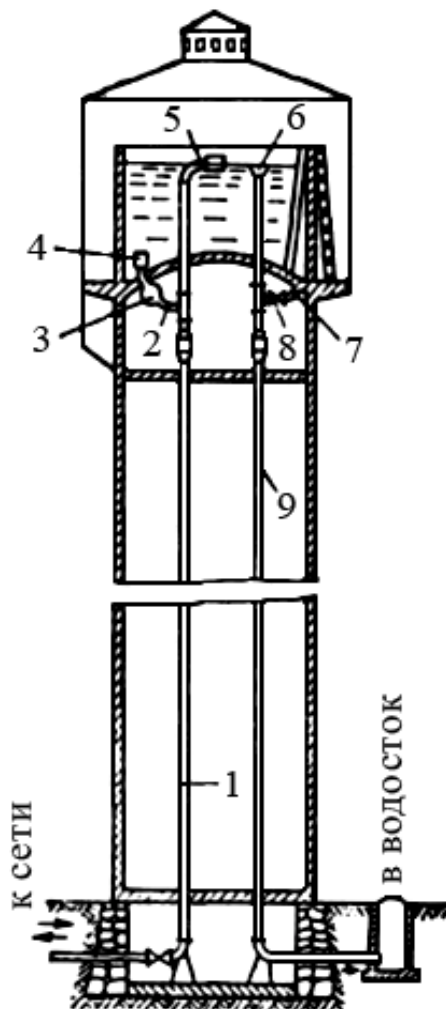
Схема оборудования водонапорной башни трубопроводами
